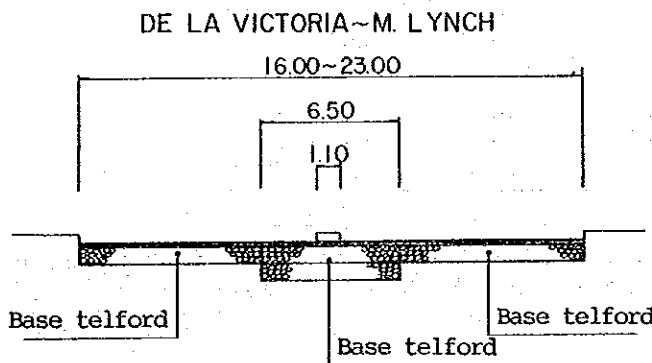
ESTADO DE PAVIMENTACION DE LA AV.E.AYALA
